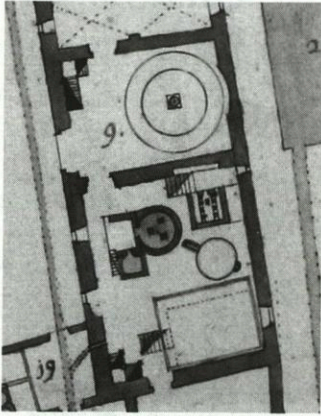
Emmeramsplatz 1 (Münchner Plan). Das obere Drittel gehört baulich zu An der Hülling 1, funktionell jedoch zu Emmeramsplatz 1.
